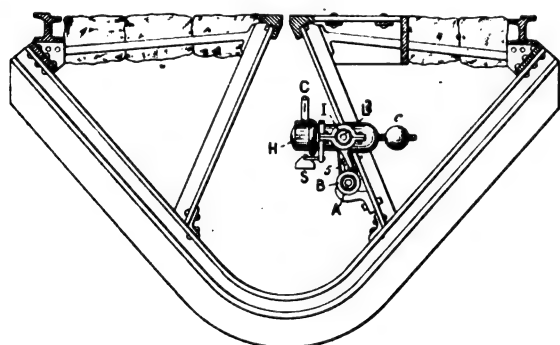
Conduite Rosenholz et Poehlman. Coupe transversale.
